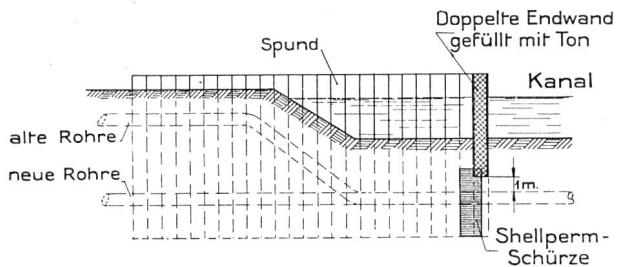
Schnitt durch die Baugrube bei Brüssel.
